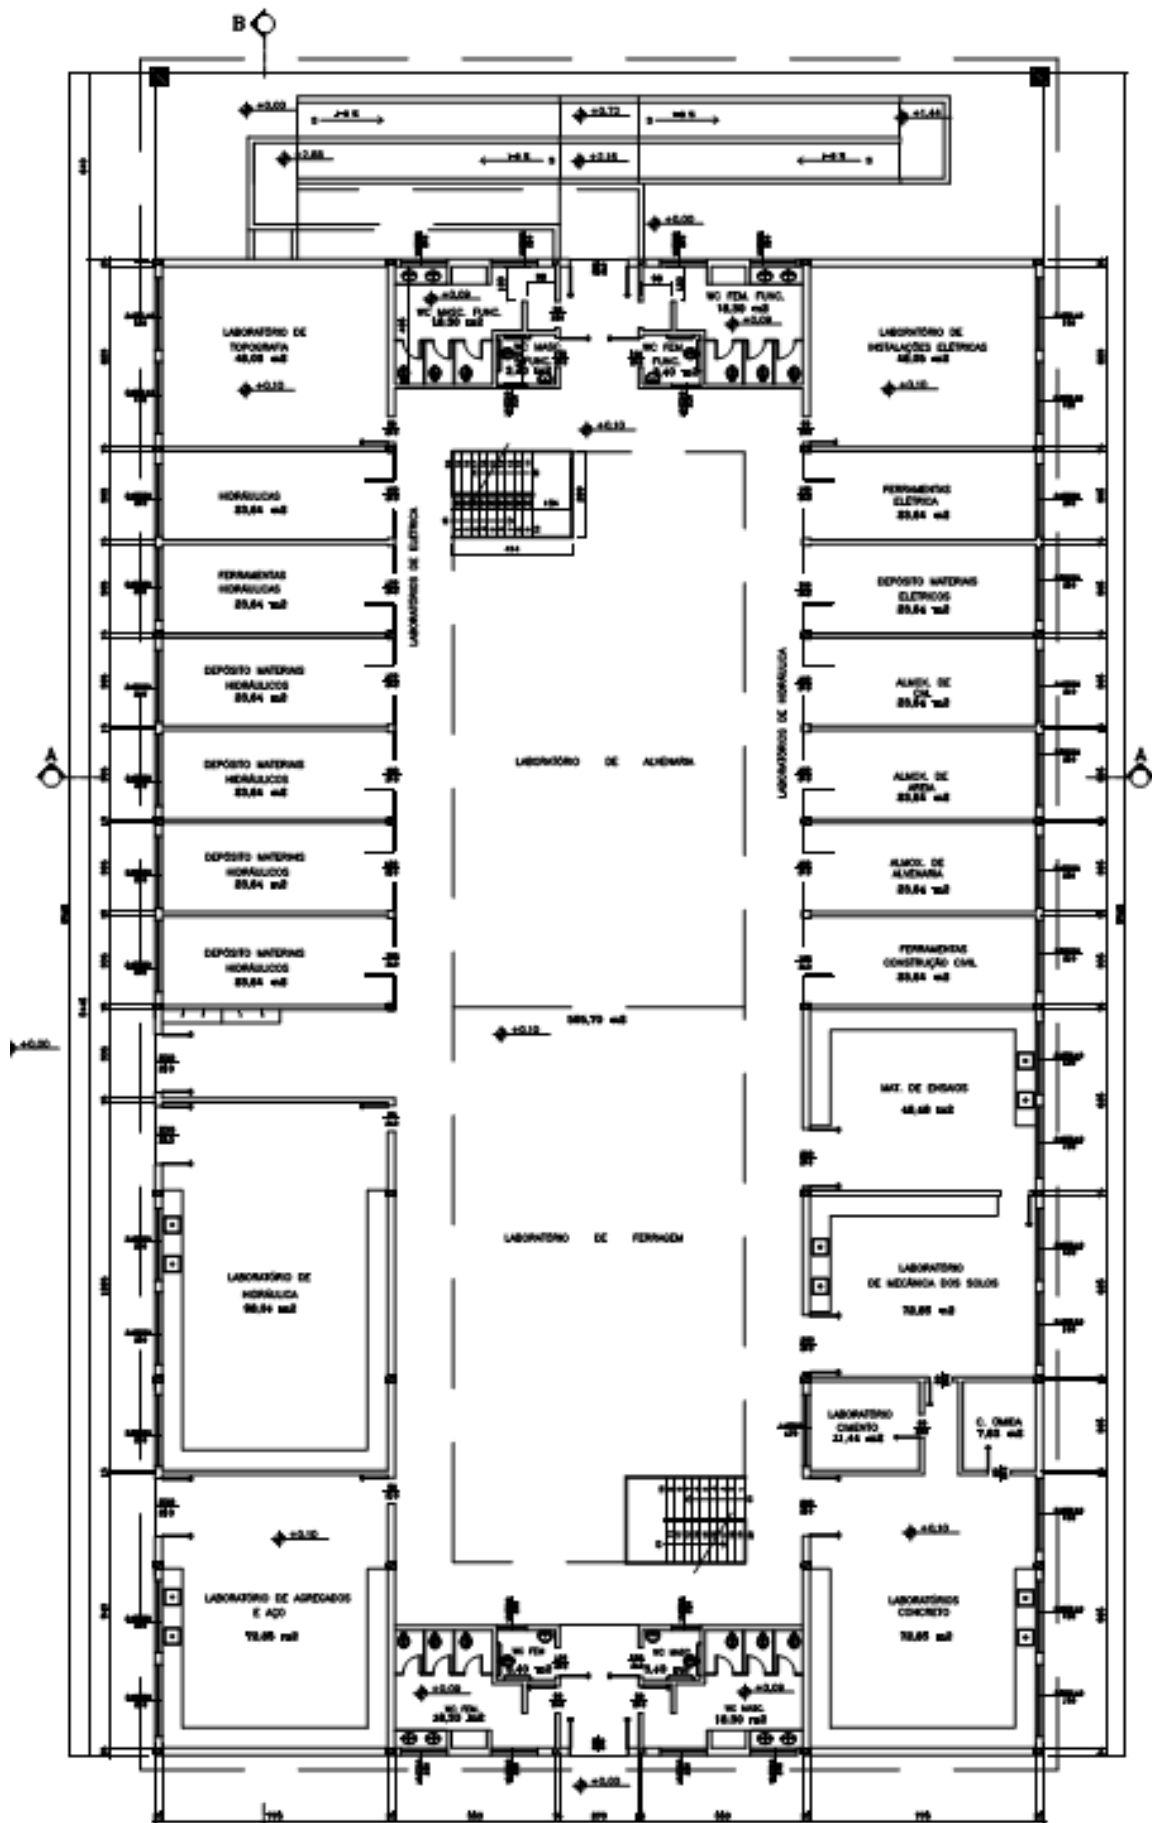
Planta Baixa do Pavimento Térreo do Bloco de Edificações.
